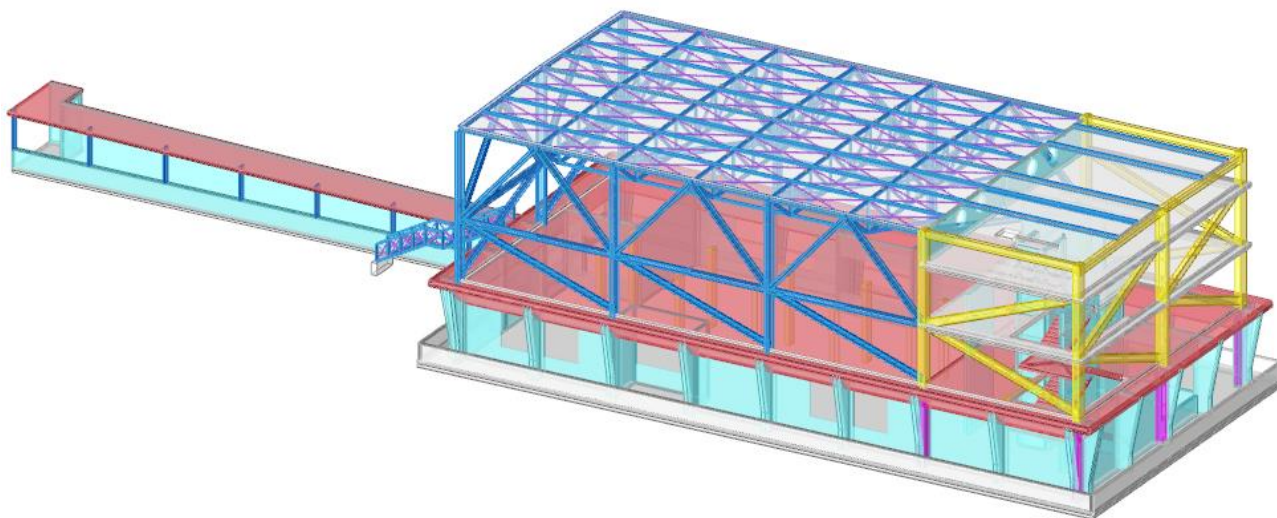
Vista 3D del Modello Strutturale FEM – Corpo A+B – Vista Assonometrica – Stato di Progetto
